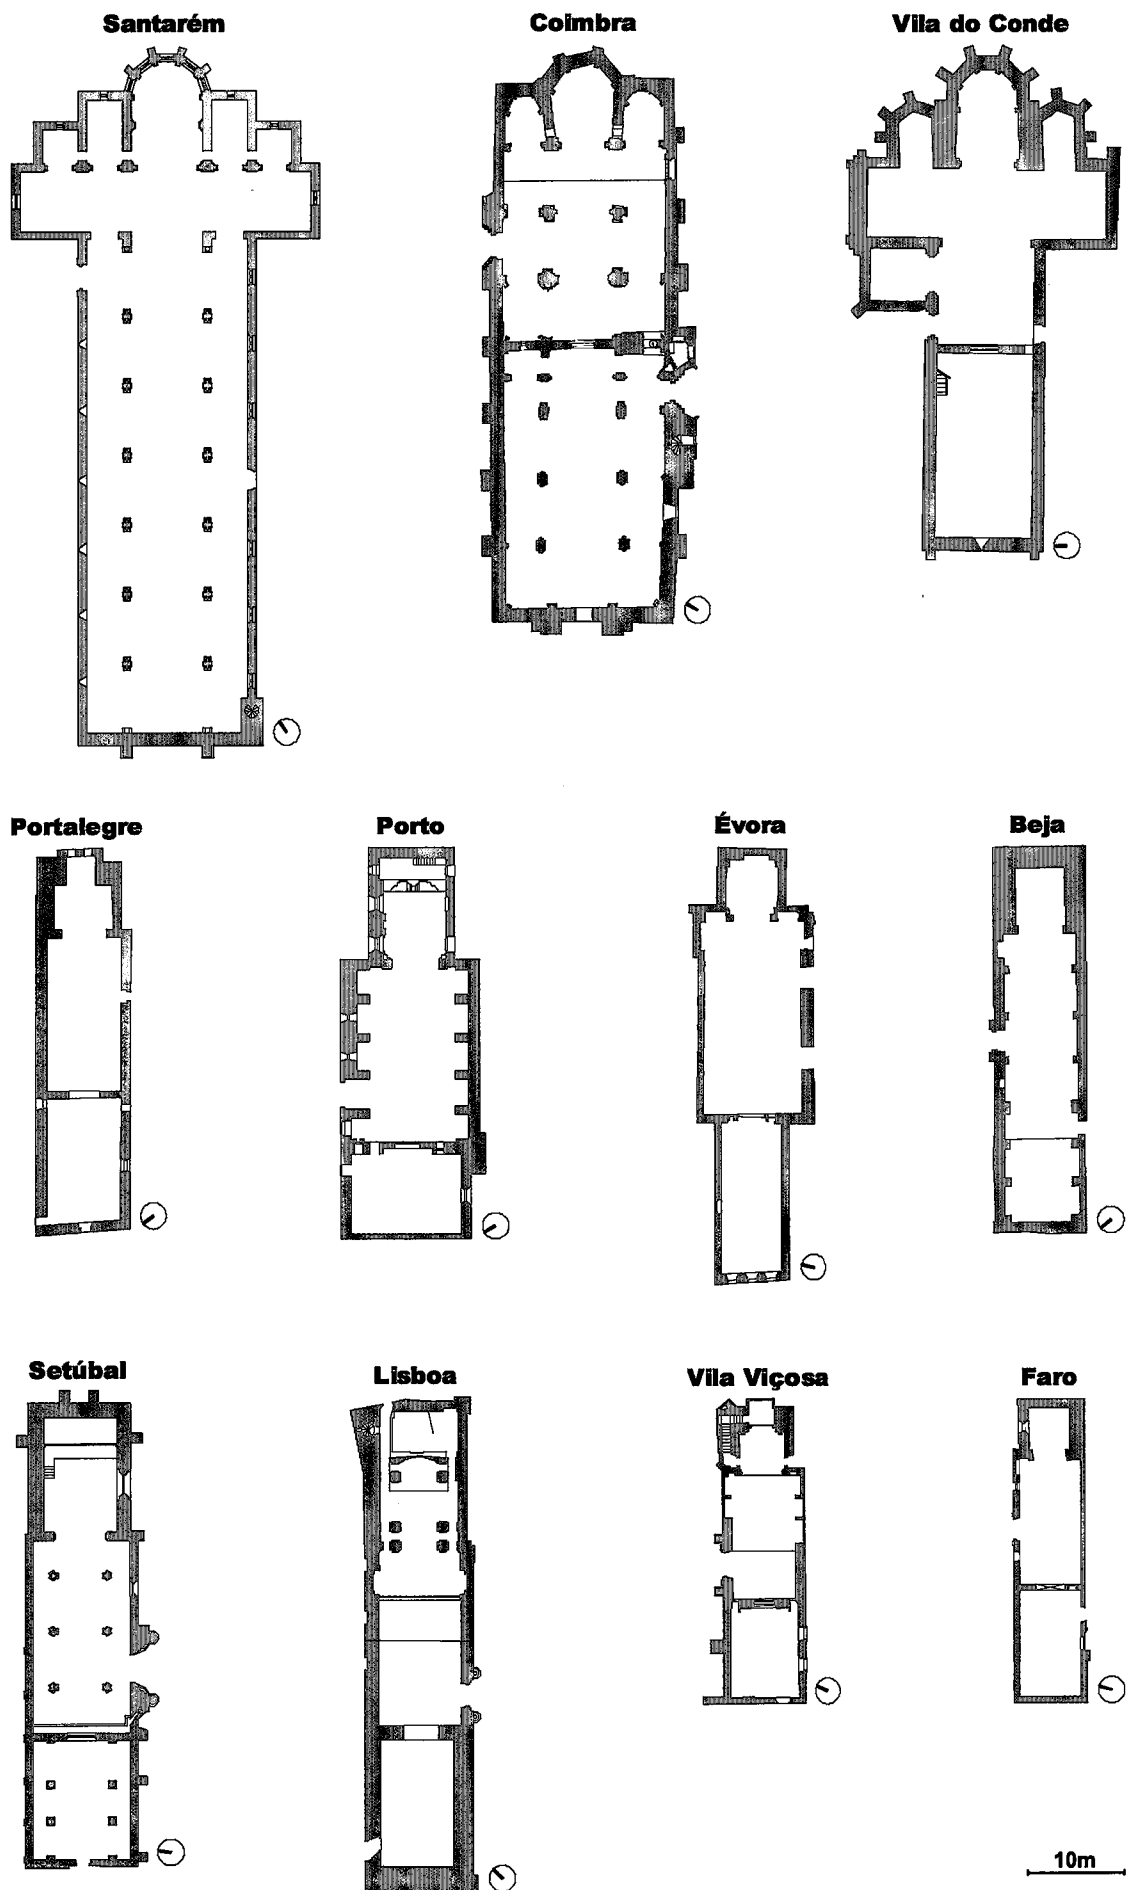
Proposta de reconstituição da planta primitiva de igrejas de Clarissas, em Portugal.
